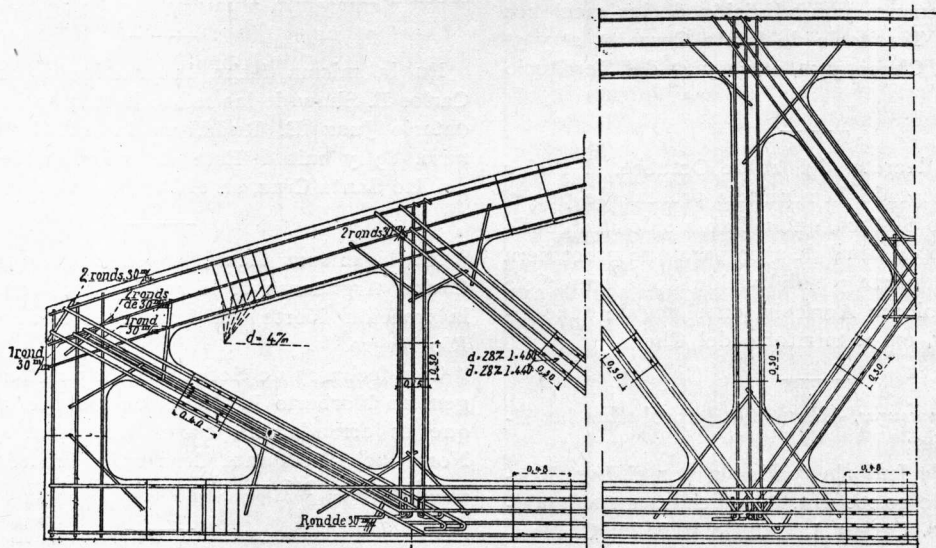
DETALLES DE LAS VIGAS PRINCIPALES
